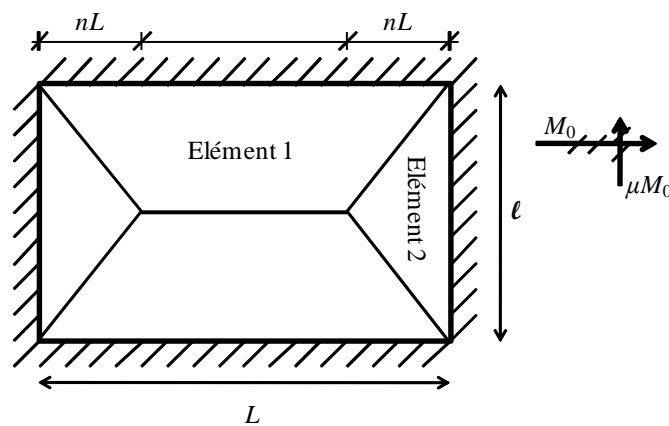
Dalle rectangulaire à ferrailage orthotrope
